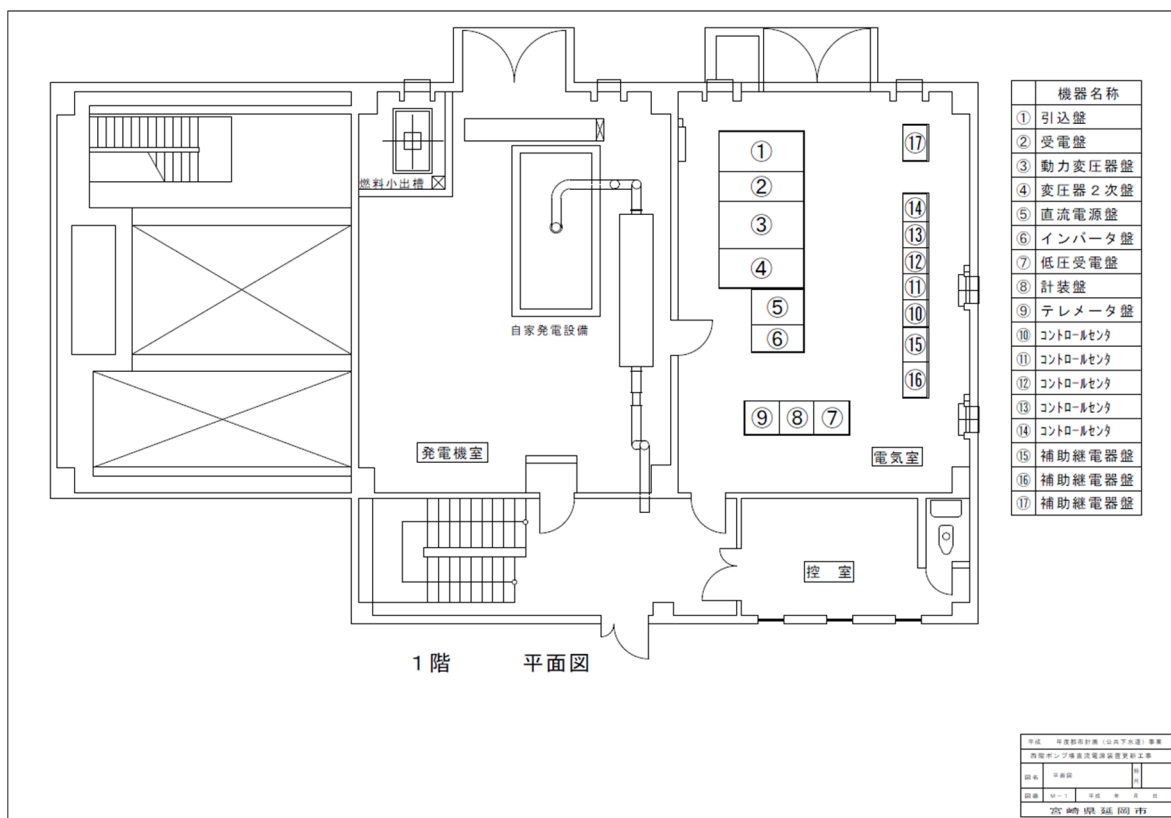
西階汚水中継ポンプ場の計画一般平面図
